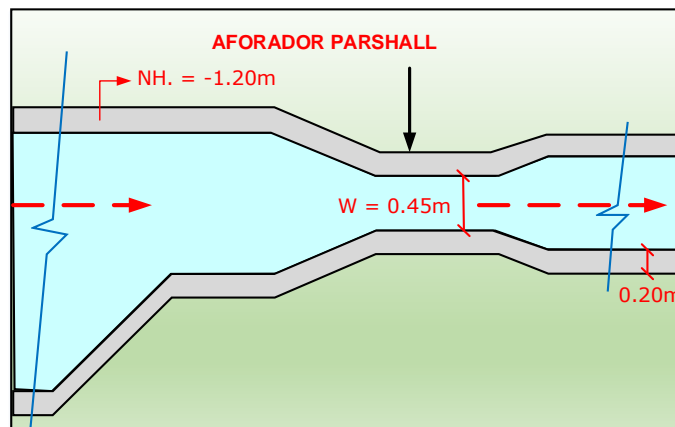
Vista en Planta del Aforador Parshall de Laguna de Anaerobia Nueva.
